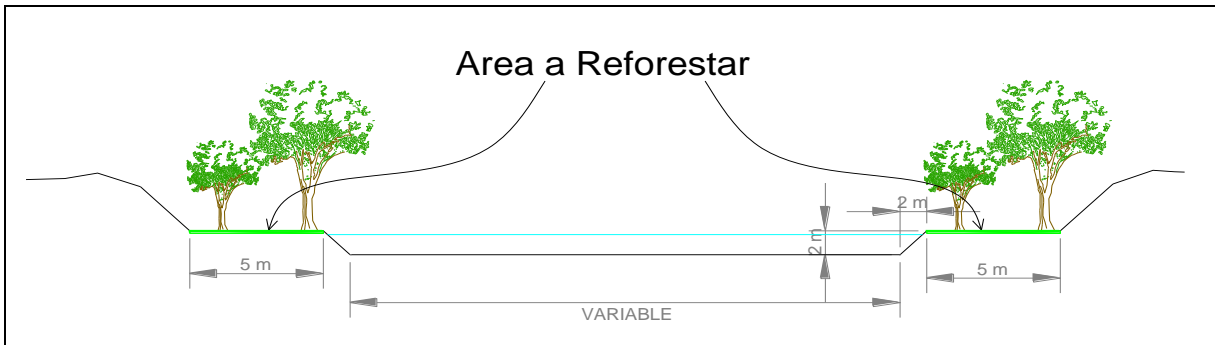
Sección tipo del cauce con el proyecto finalizado.
